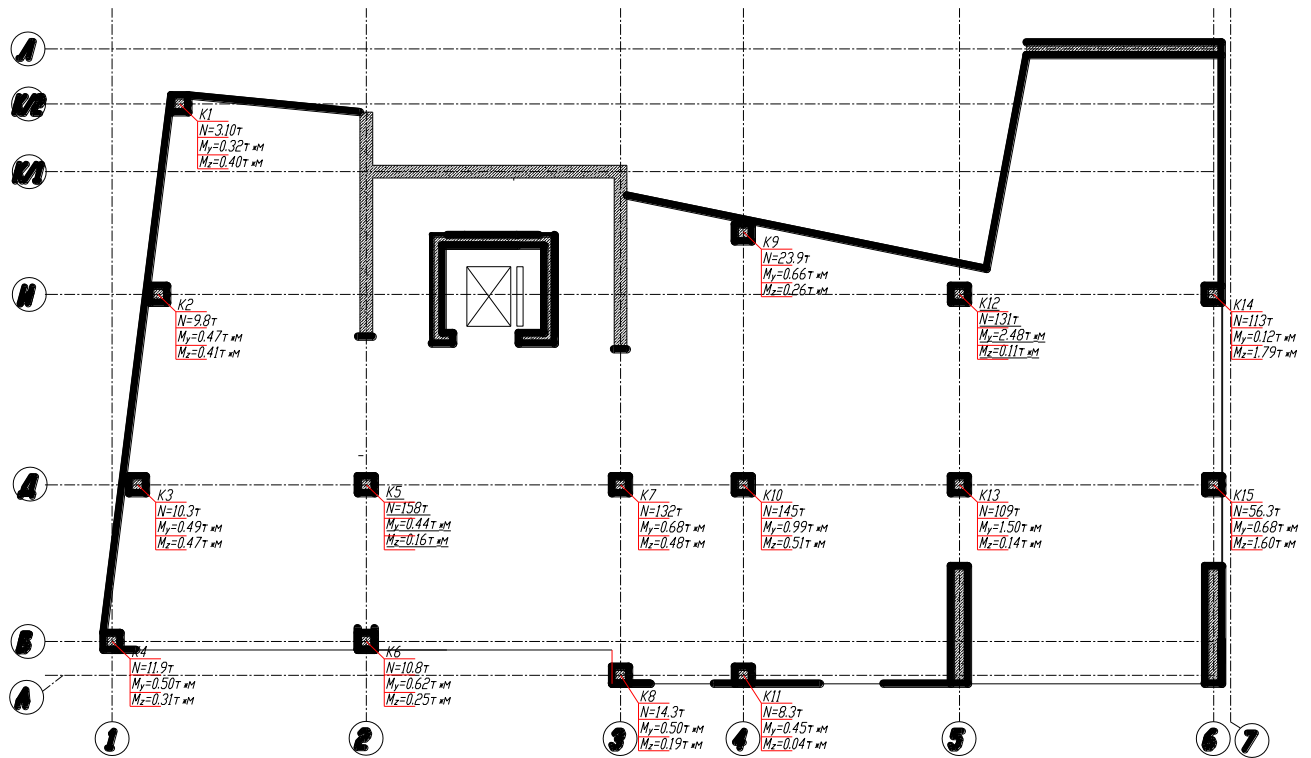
Навантаження на фундамент від РСН 3
